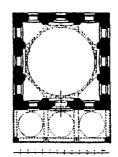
مسقط أفقى لمسجد قاسم باشا في أدرنة . (عن أصلان ابا) .
